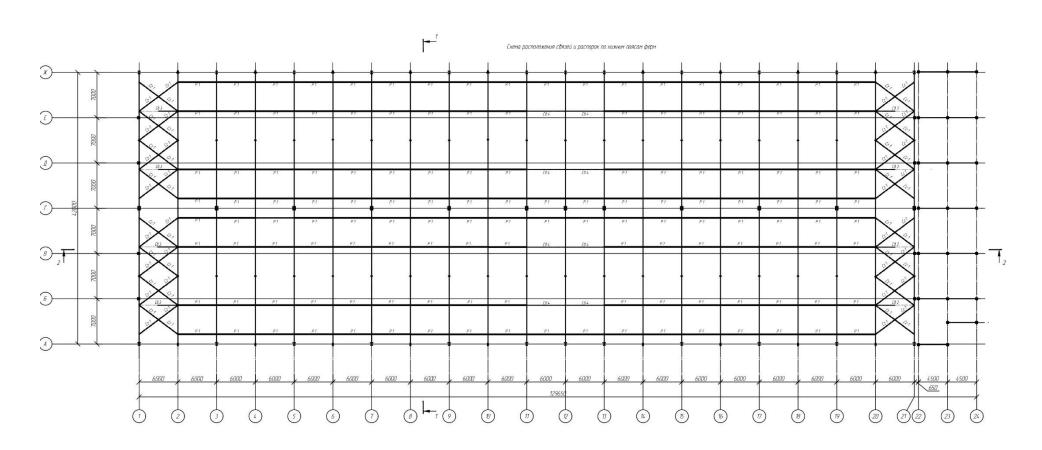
Схема расположения связей и распорок по нижним поясам ферм
